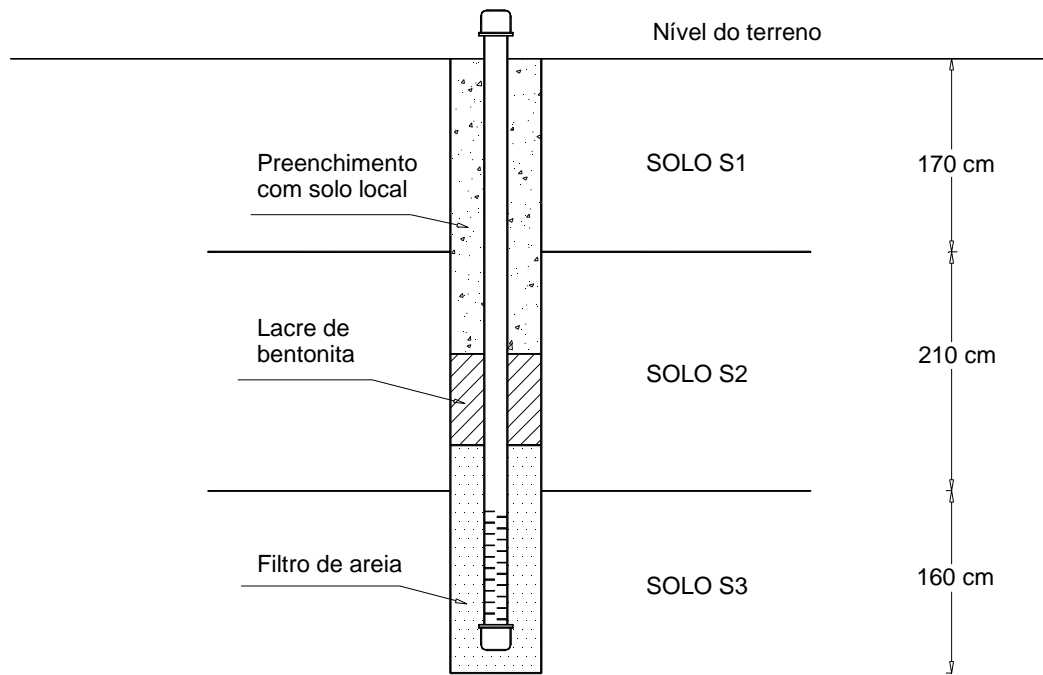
Croqui da instalação do piezômetro, do tipo Casagrande.
